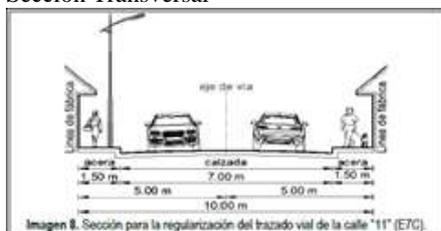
Sección para la regularización del trazado vial de la calle "11" (E7C).
